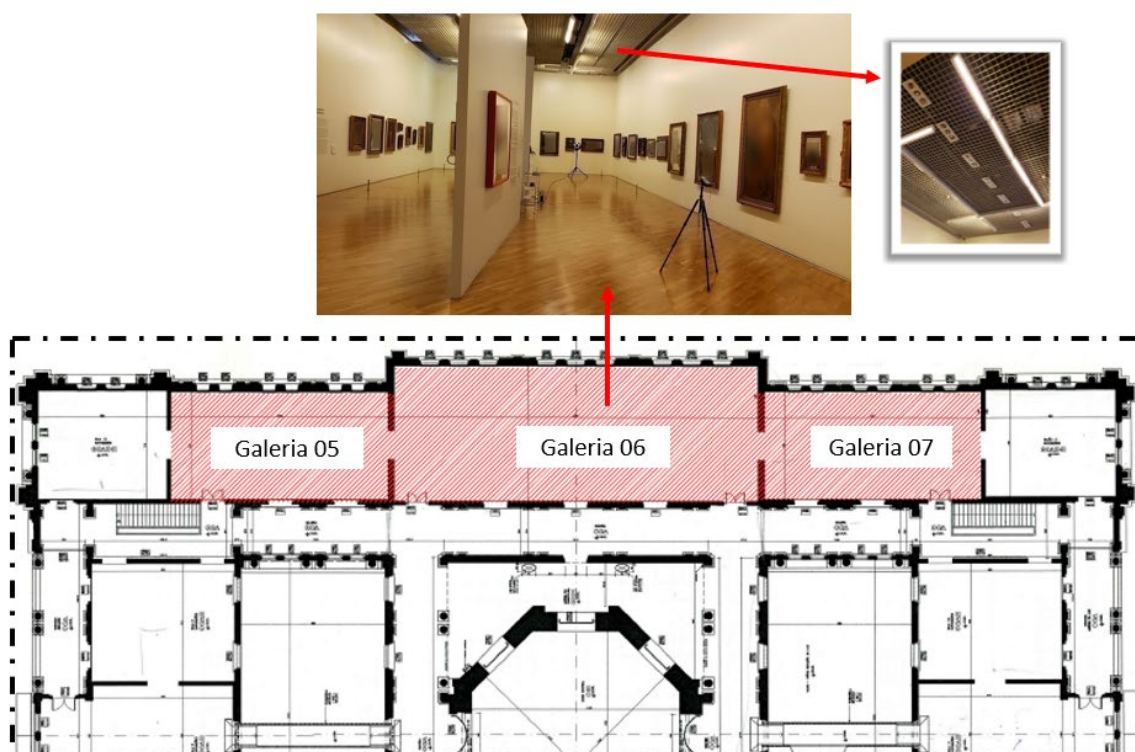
Parte da planta do segundo pavimento com imagem da sala estudada (Galeria 6) e um detalhe do forro.
